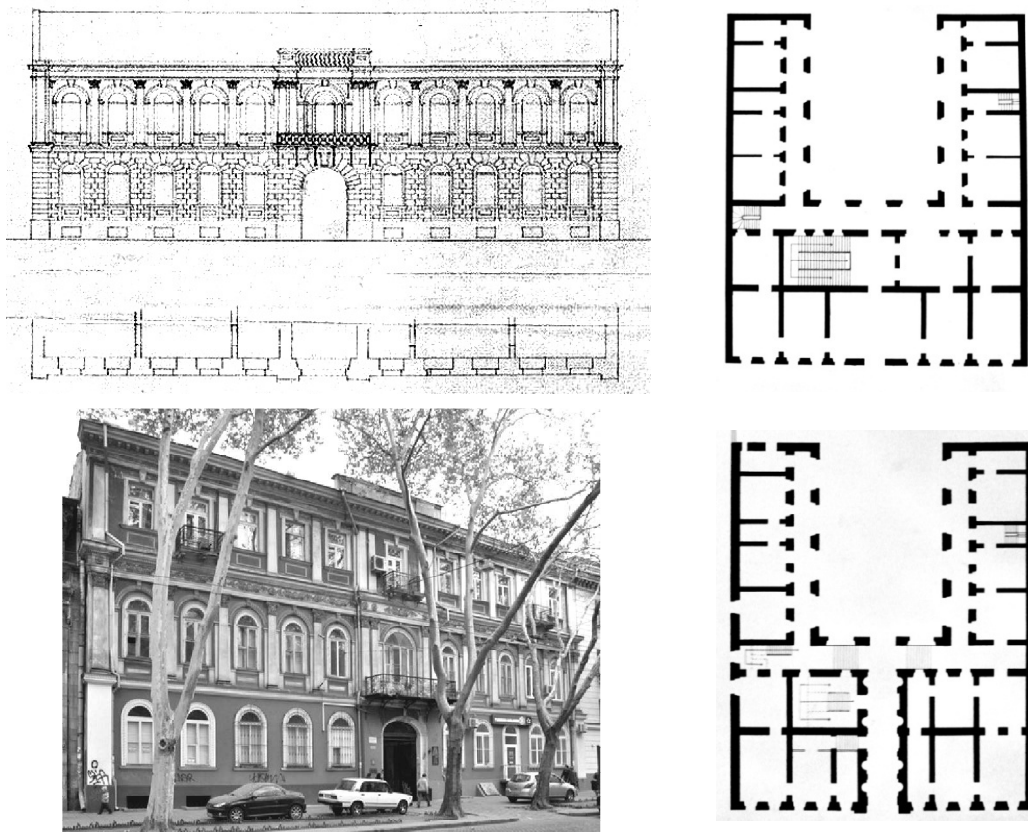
Будинок П. Вучині за адресою Пушкінська, 19, 1847–1849, арх. Ф.І. Моранді, 1887, Ф.В. Гонсіоровський. Креслення фасаду [22], планів I і II поверхів [10;11], Перспектива (фото автора)
